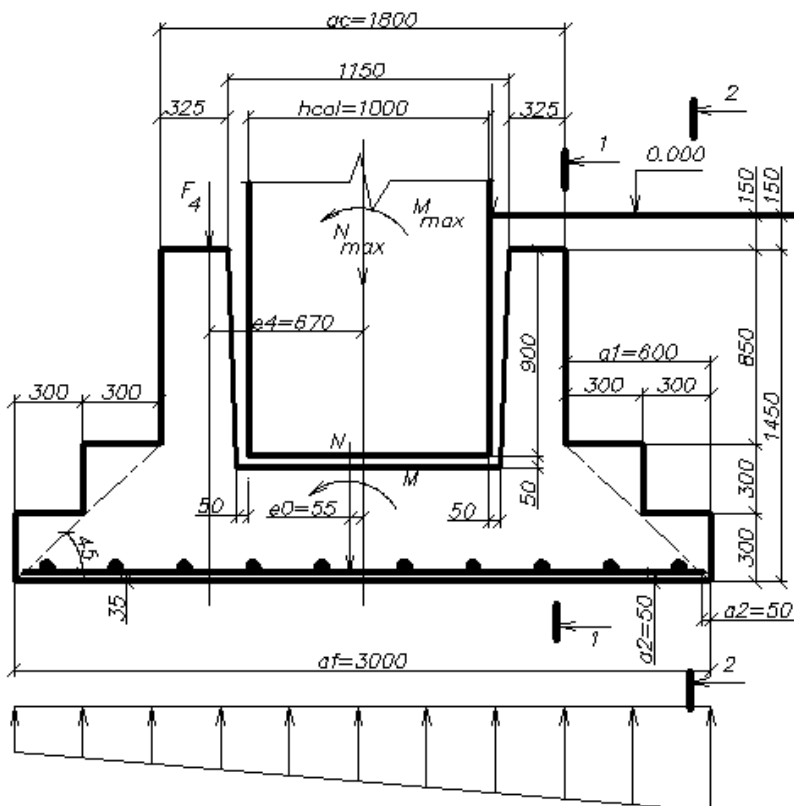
Ступенчатый фундамент: а) расчетная схема фундамента и эпюра давления на основание
